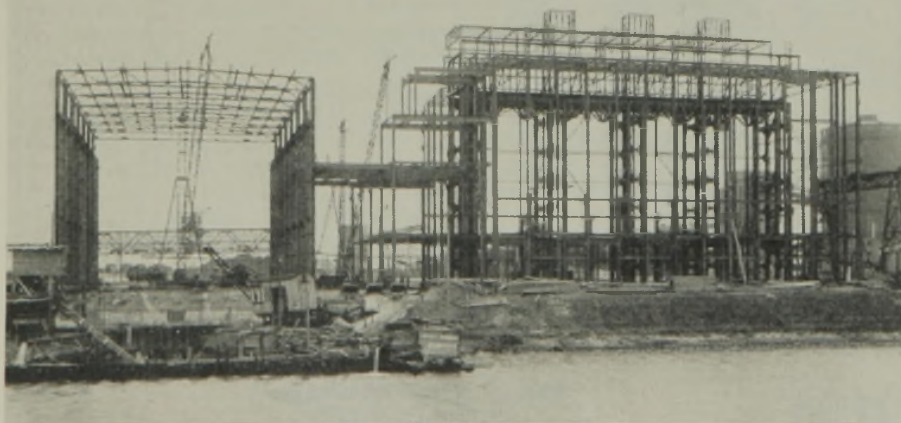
Stahlkonstruktion von Maschinenhaus, Vorwärmanlage und Kesselhaus.
